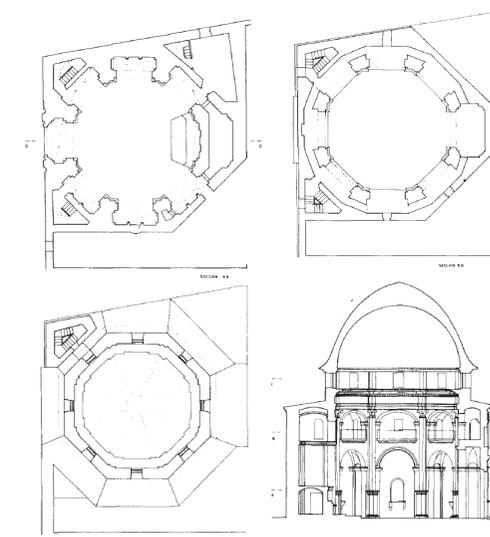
Plantas y sección de la capilla Ecce-Homo.
